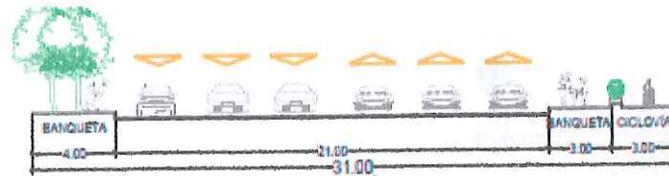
E-02. Estructura vial Plan Maestro Distrito Norte. Fuente. Elaboración Propia
